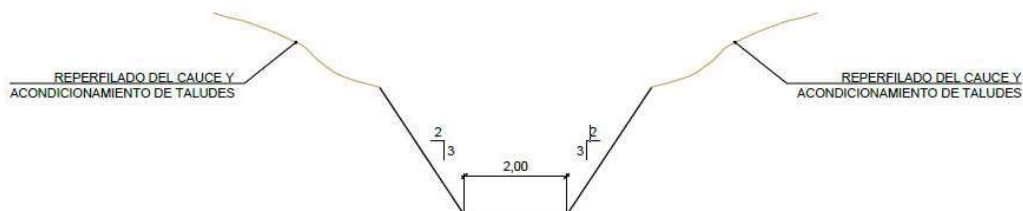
Sección de cauce proyectada, definida en los planos P.05.03
